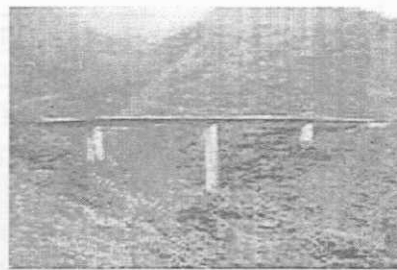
Losa/Viga 2 Vigas. Puente Chirajara (Regional Meta).
